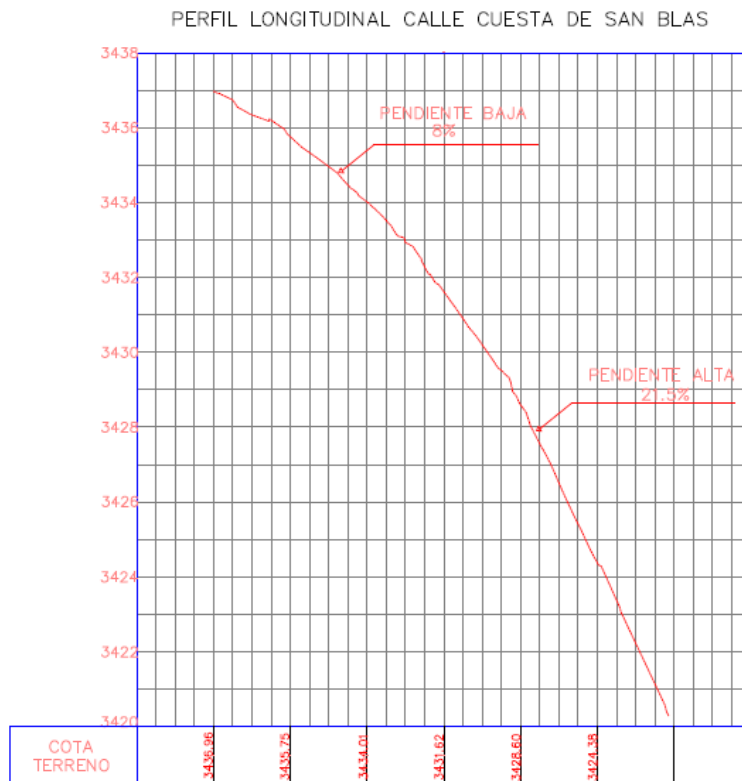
Perfil longitudinal calle Cuesta San Blas estado actual
